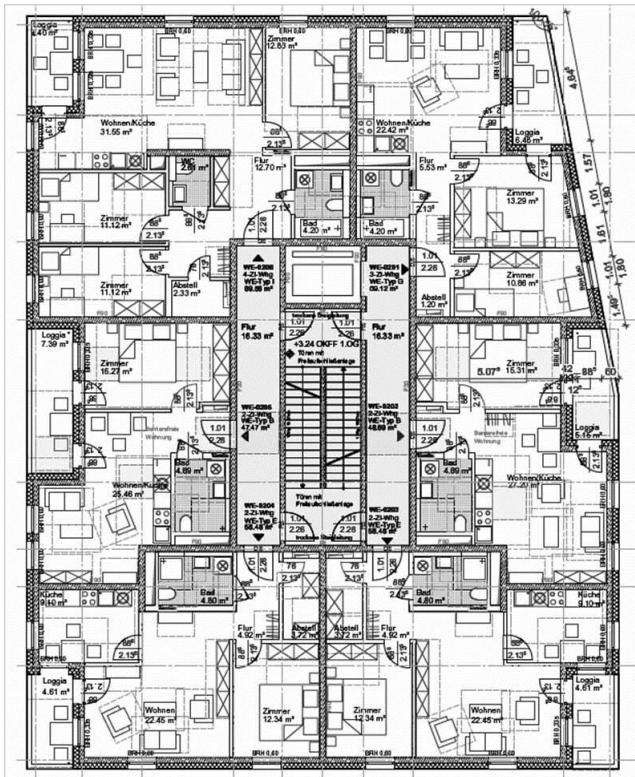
Grundriss für ein Normalgeschoss des BV Sewanstraße. Der Baukörper ist sehr kompakt und weist deshalb einen sehr hohen Effizienzstandard auf.
